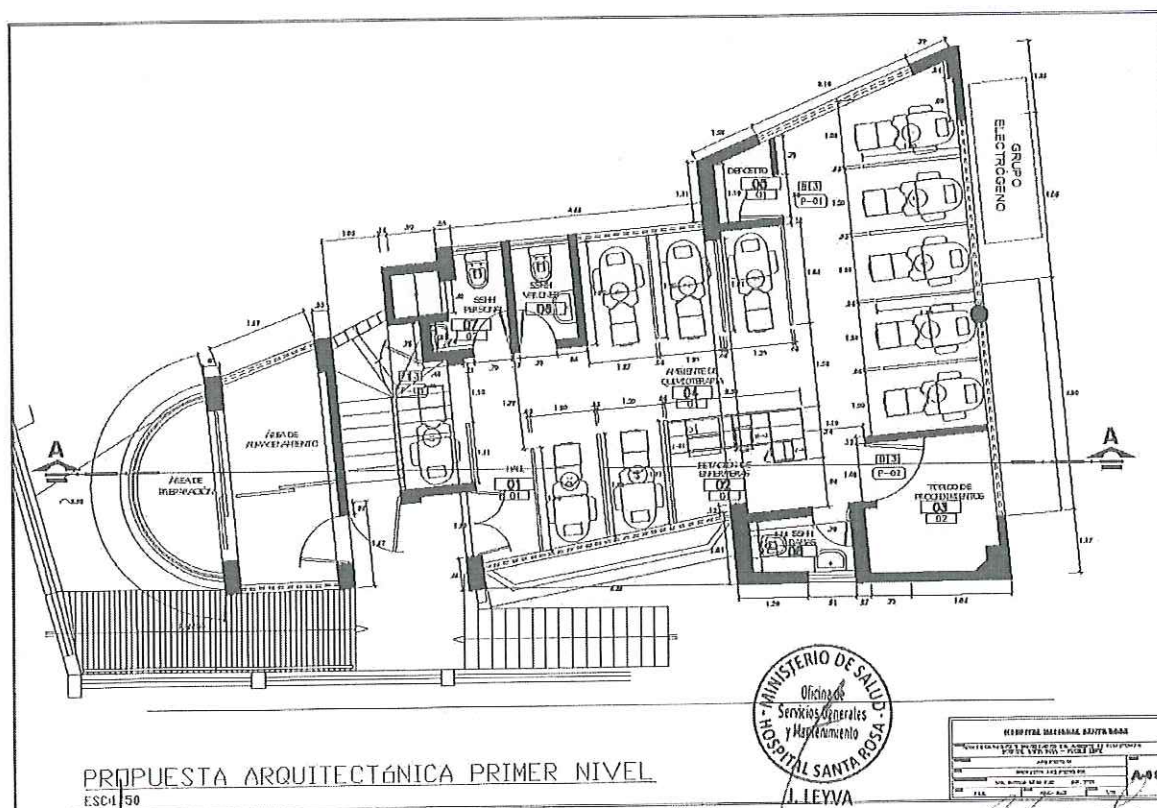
Propuesta Arquitectónica Primer Nivel
